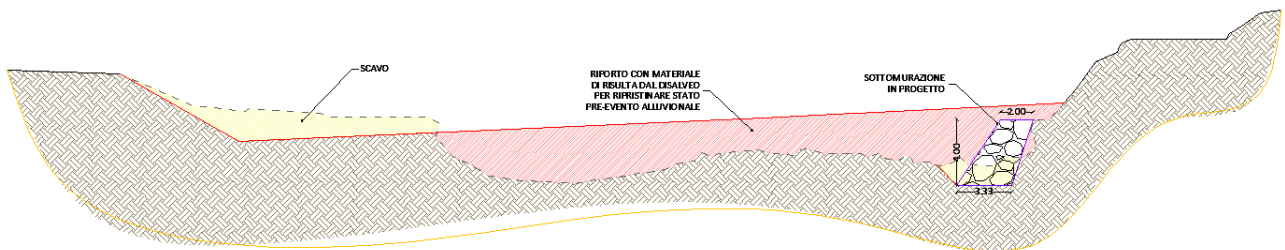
Sezione tipo 2, tratto d'alveo con sottomurazione in progetto
